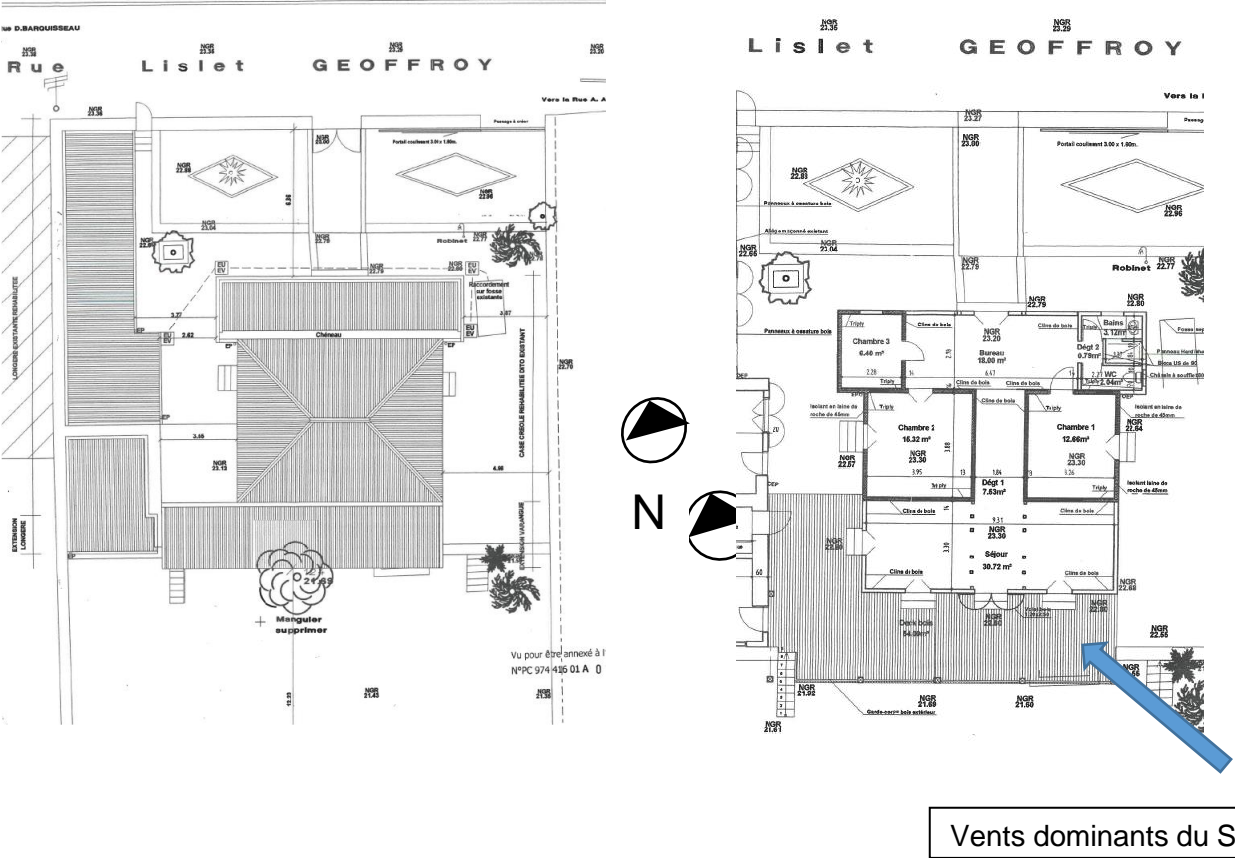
10: Plan de masse et plan de rez de chaussée – © Antoine Perrau architectures
